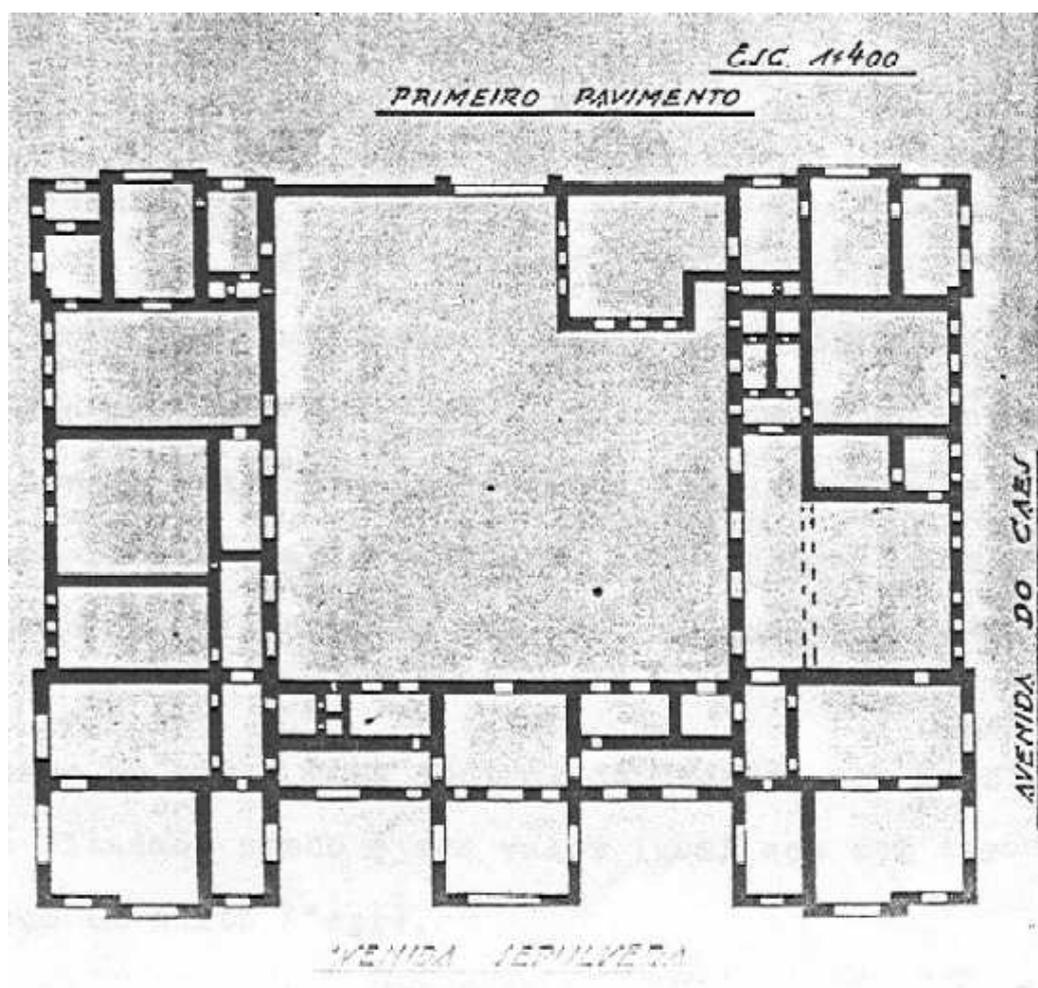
Cópia da Planta Baixa original do prédio da Alfândega.
